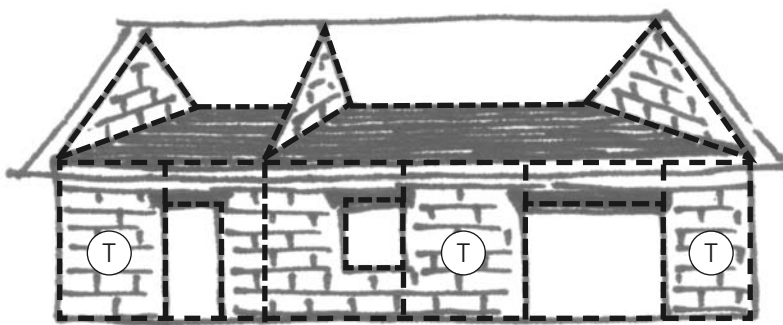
Principe de chaînage d'une construction en maçonnerie. Un plancher béton assure la fonction de diaphragme rigide : il solidarise l'ensemble des murs du bâtiment.
